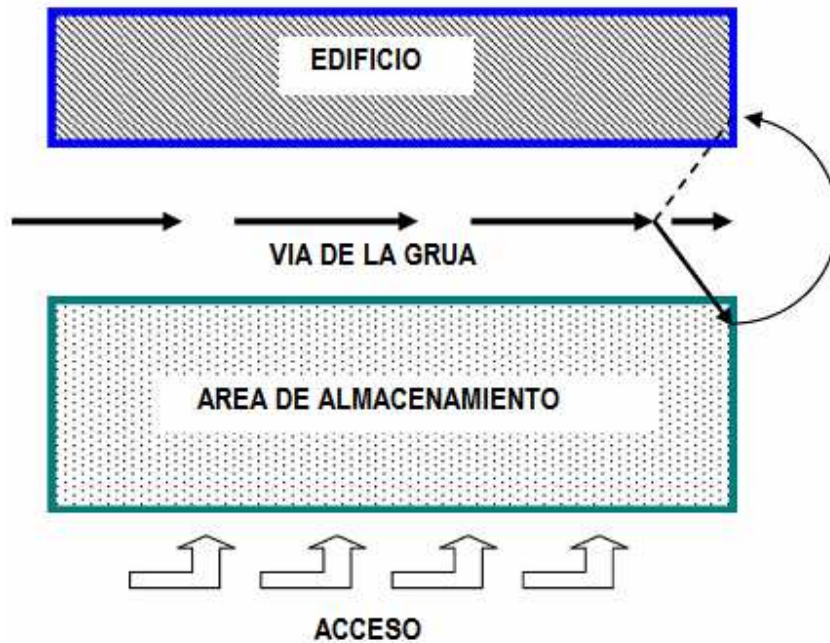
Vías de acceso al área de almacenamiento de los elementos prefabricados.
